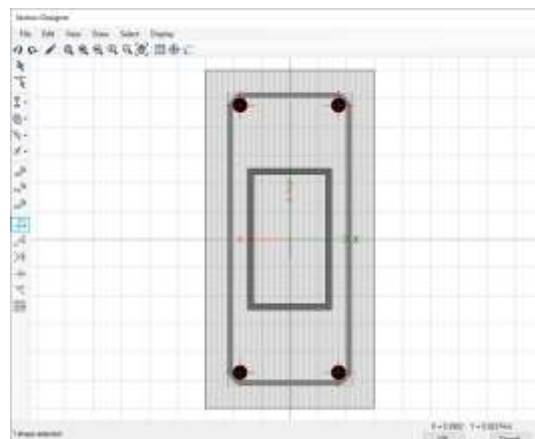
Definición de columna de 30x60 reforzada con perfil metálico tubular rectángulo
